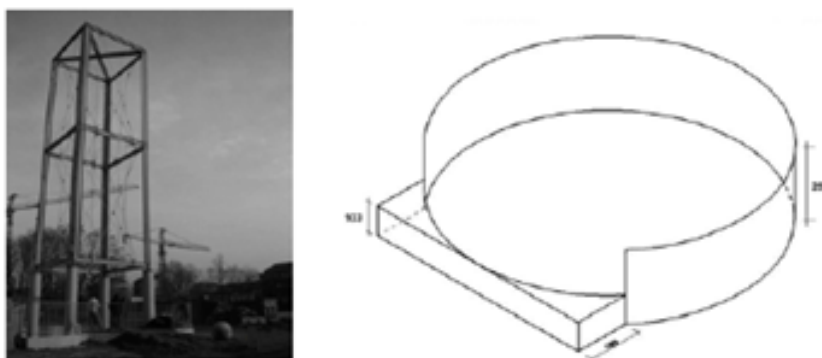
Dispositif de largage et schéma de la cuve d'essai de Calvetti et al. (2005)
